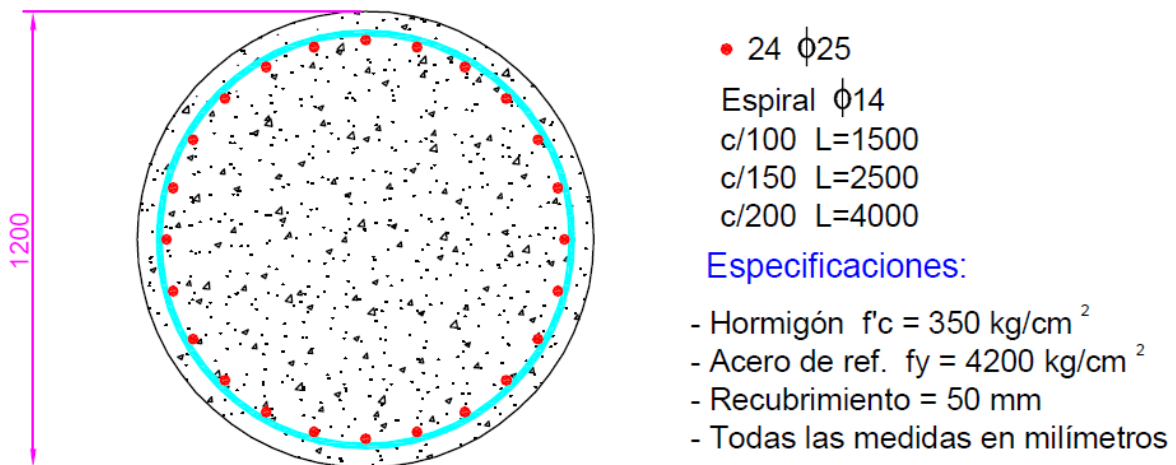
Distribución de acero de refuerzo en columna de la pila – ejemplo 3.2
